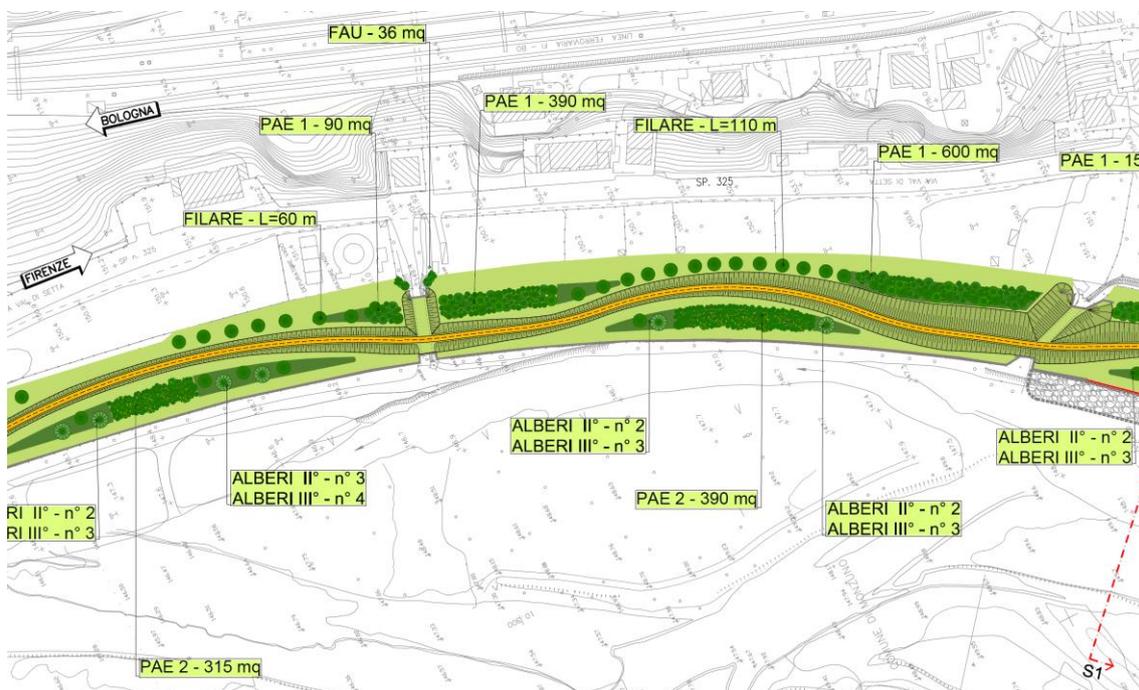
Estratto planimetria delle Opere Verde – Pista ciclabile
